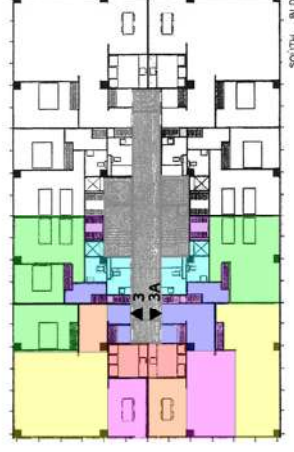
Planta Pavimentos Tipo Bloco Norte e Sul
